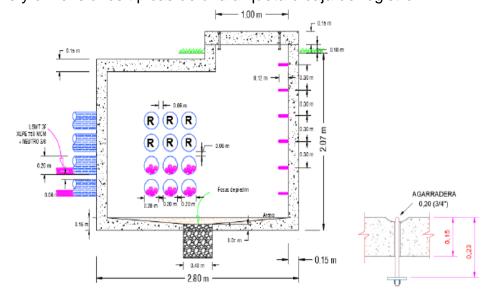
Caja de registro-AutoCAD Fuente: Criterios para construcción de redes soterradas DN-DS.
